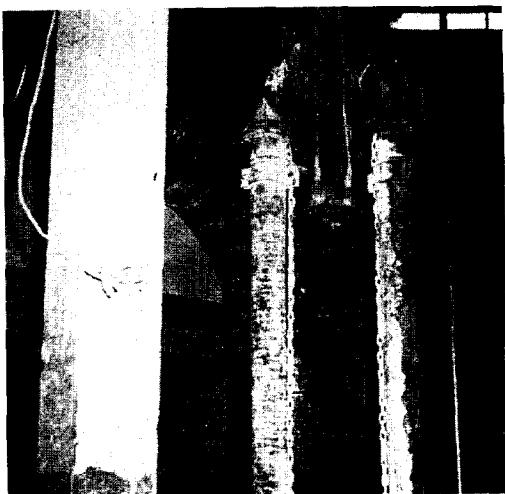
Concrete 타설용 Pipe의 끝부분.
